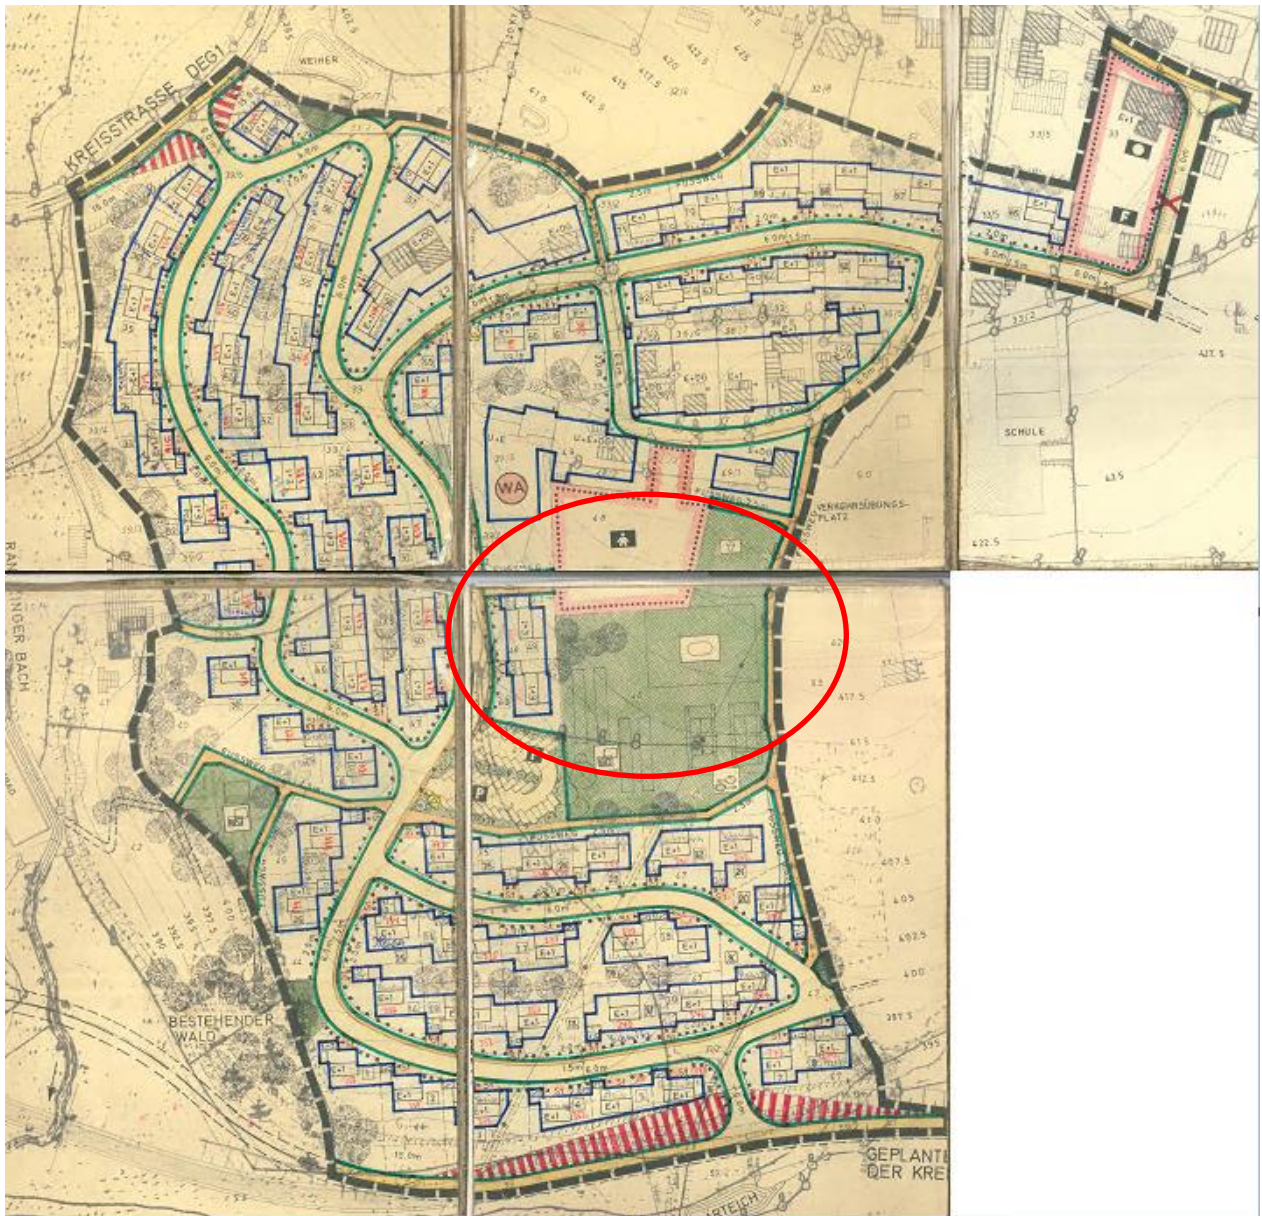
Bebauungsplan „Jägerhölzl“ ohne DB 1, maßstabslos
